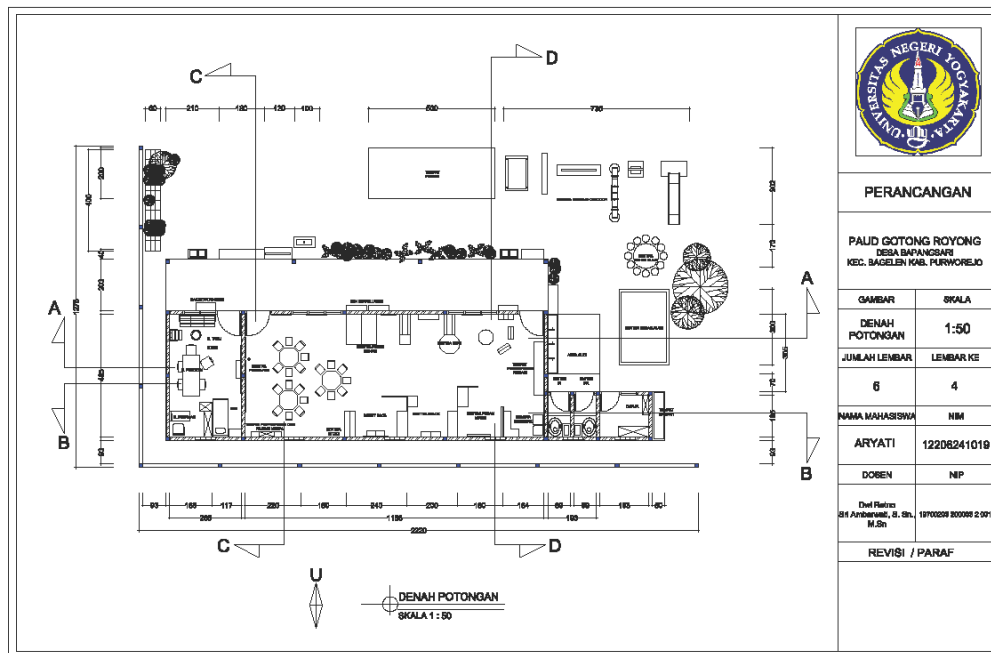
Denah Lantai Ruang PAUD Setelah Revisi
